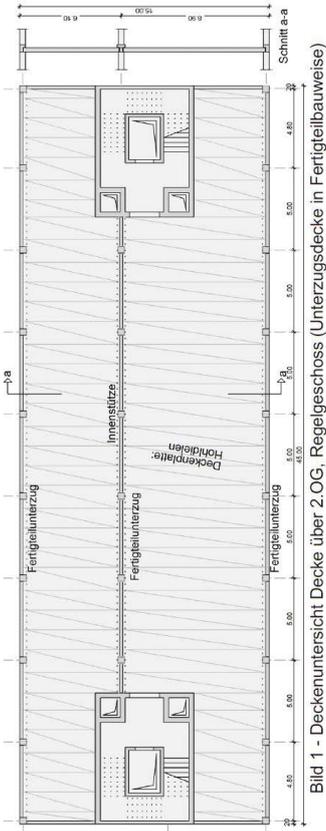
Deckenuntersicht Decke über 2.OG, Regelgeschoss (Unterzugsdecke in Fertigteilbauweise)
